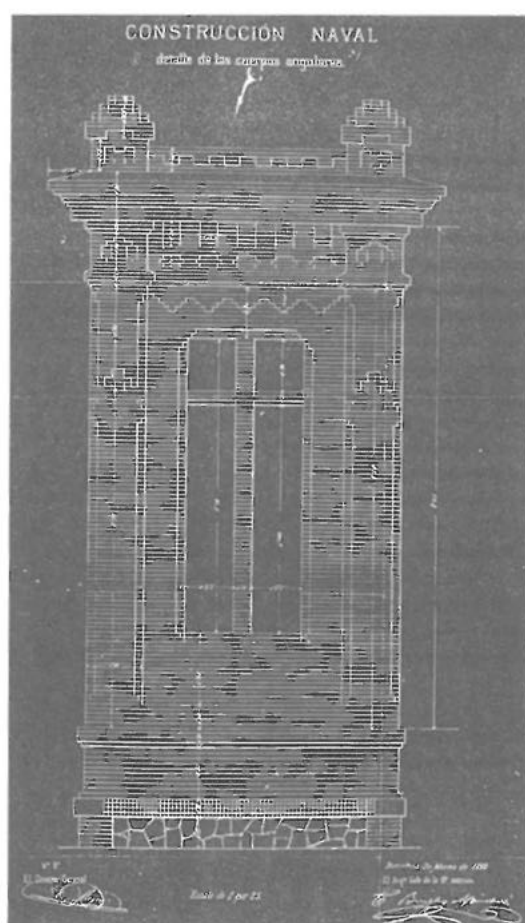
Detalle de los cuerpos angulares del Pabellón de Construcción Naval. Fotografía Cátedra Gaudí.
